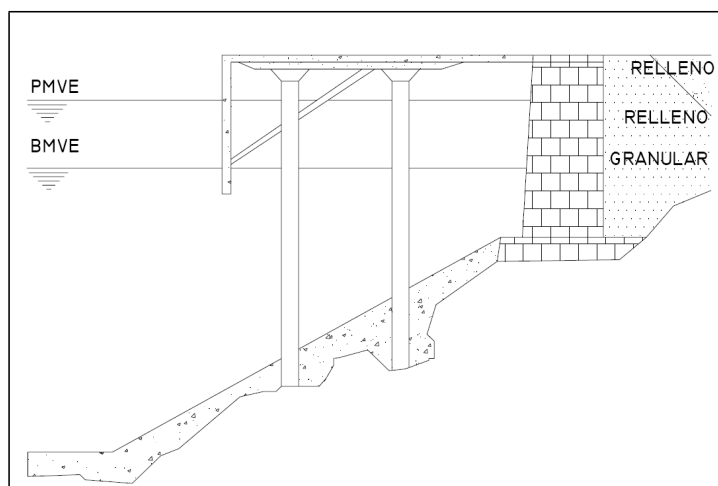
Sección tipo de un muelle mixto de pilotes y muro de contención
